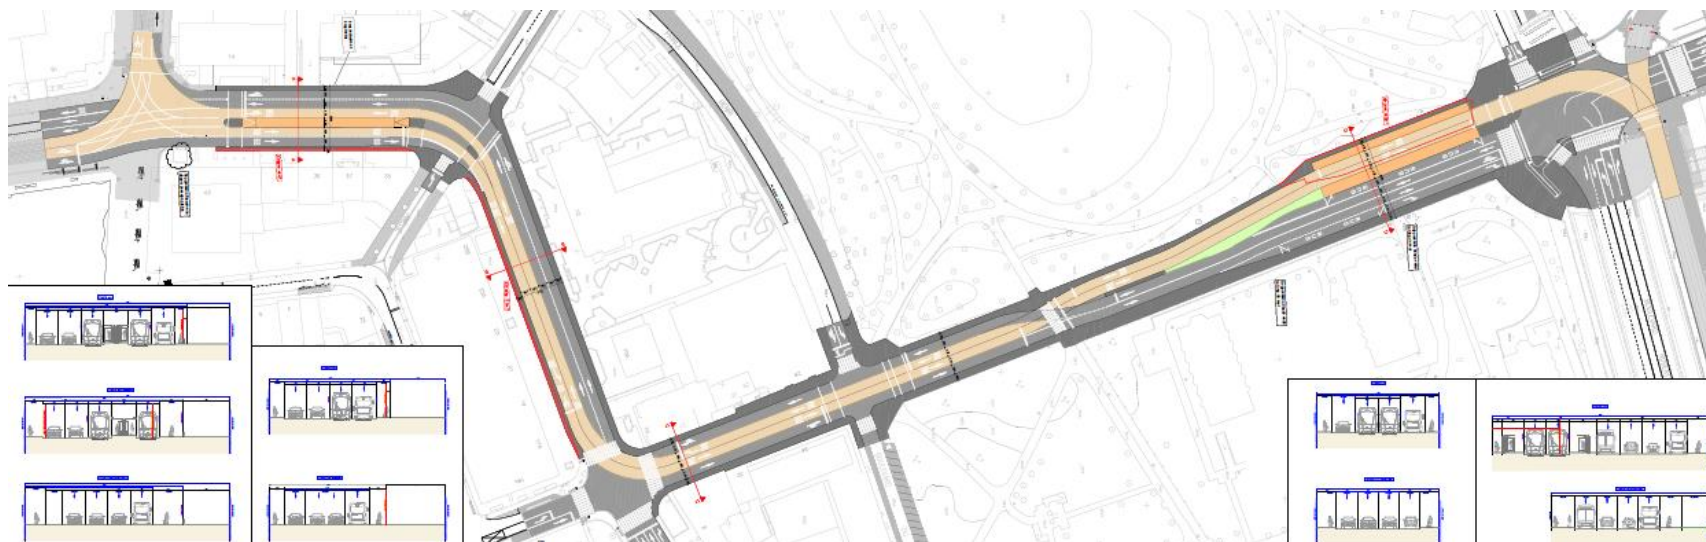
Vues en plan et en coupe de la section située en centre-ville (Boulevard Royal et Avenue de la Porte-Neuve). Version originale en annexe 03 (TRAMP, 2021).
